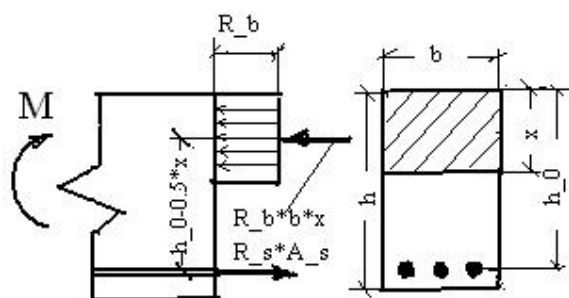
Расчетная схема железобетонного изгибаемого элемента прямоугольного сечения
